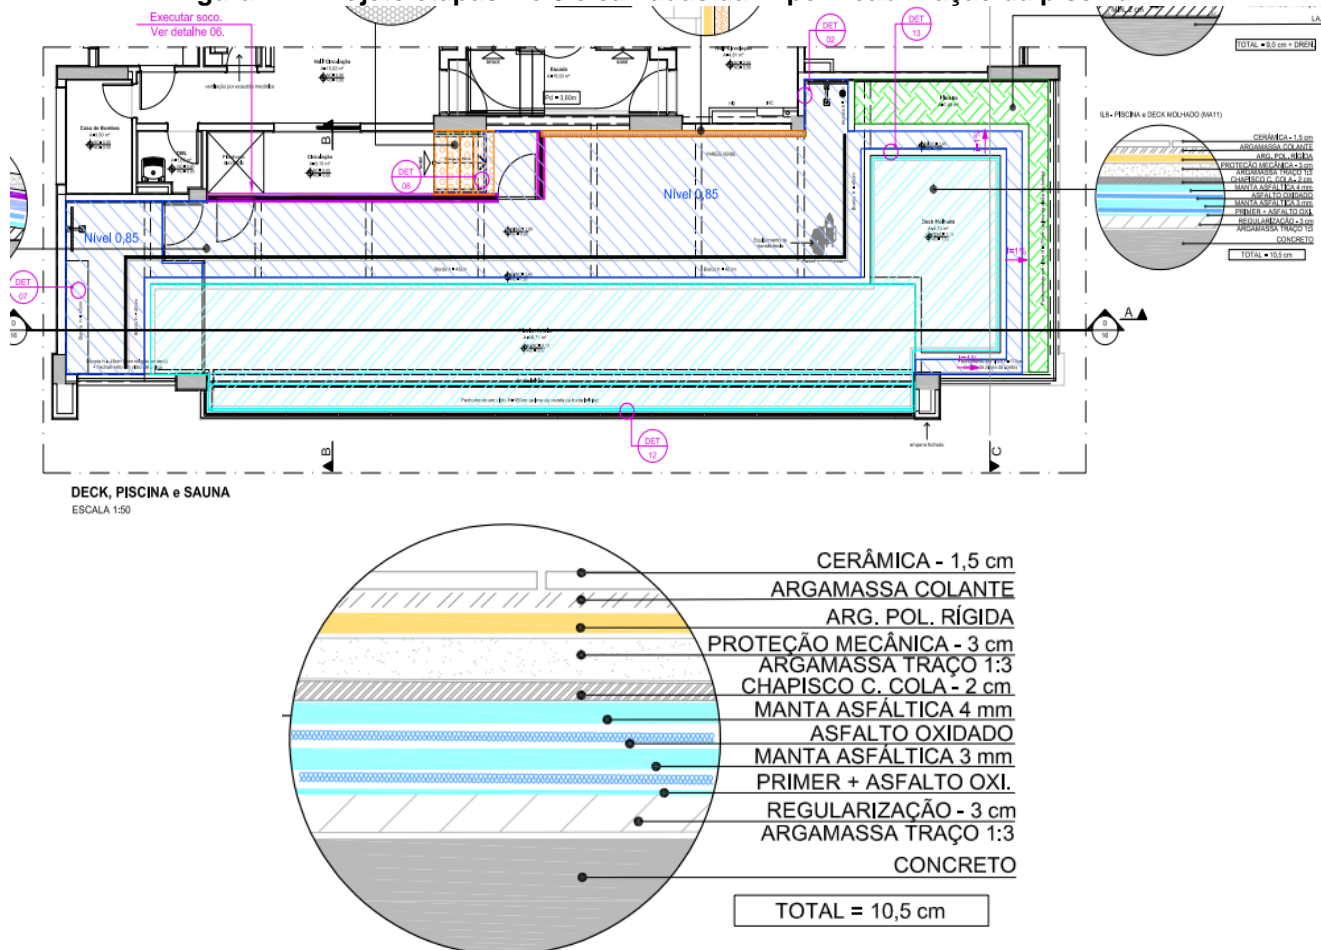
Projeto da primeira etapa e camadas da impermeabilização da laje do pavimento lazer
